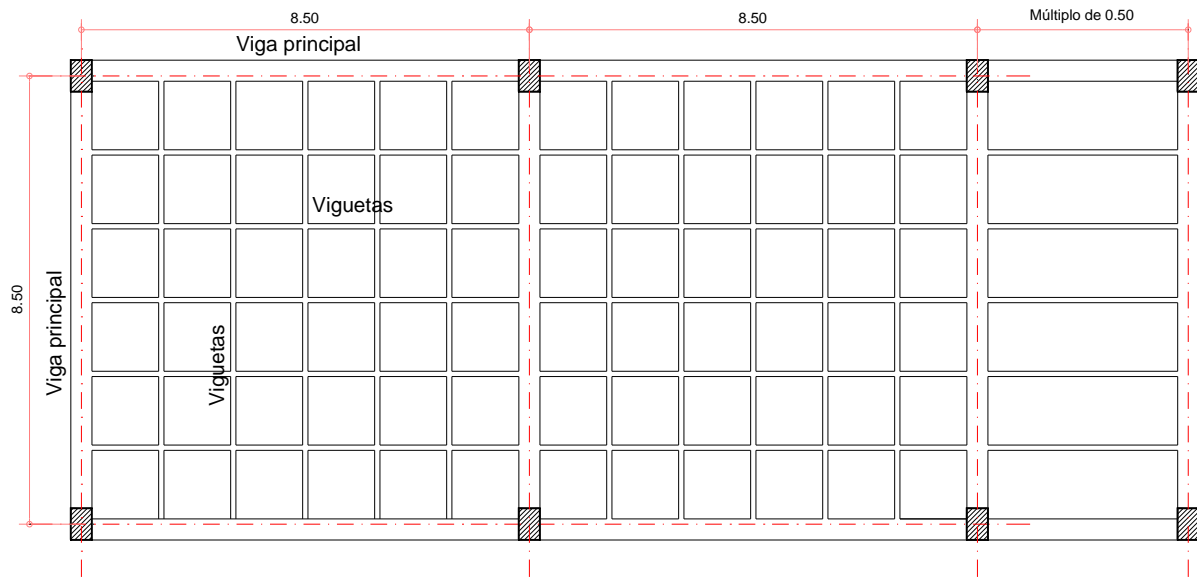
Propuesta sistema de entrespaño en concreto reforzado combinado armado en una dirección y en dos direcciones
